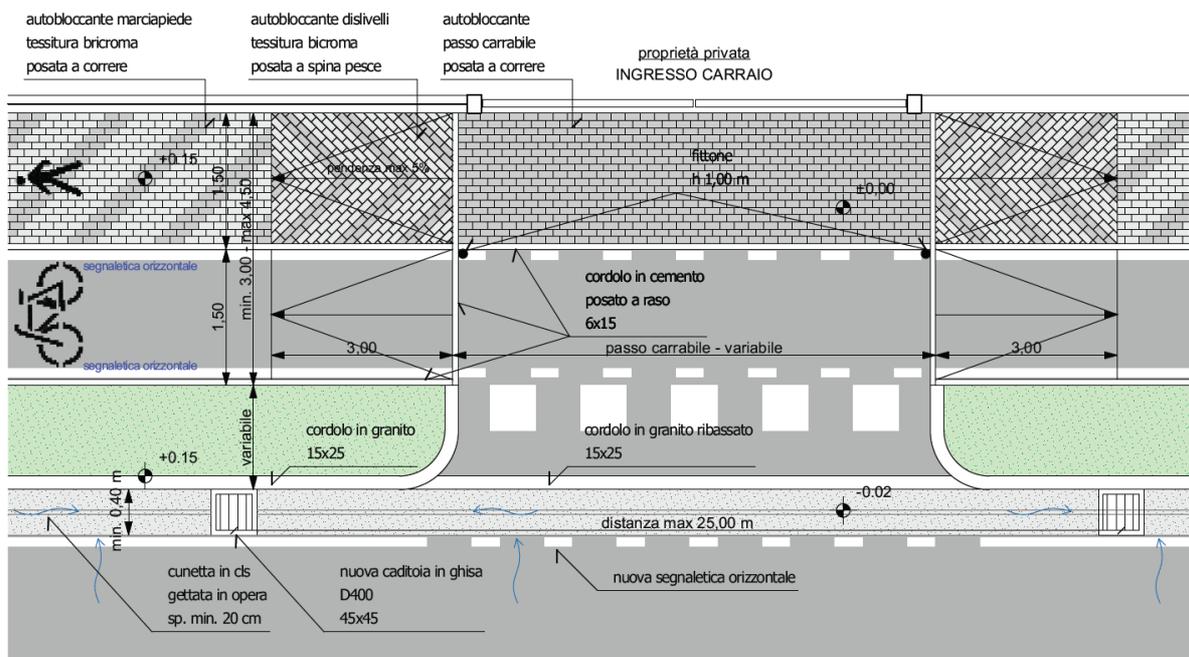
Estratto Tav. 6.9 – Dettagli
